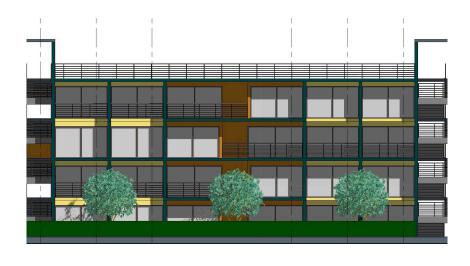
Sección de fachada donde se diferencia estructura de viviendas. Fuente: Elaboración propia.
